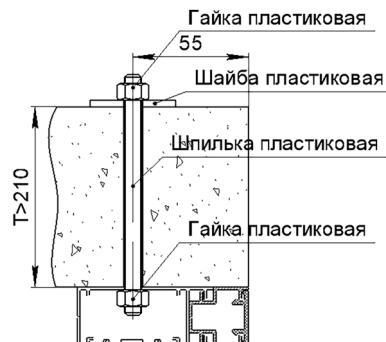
Установка на бетон (сэндвич-панель/бетон)
